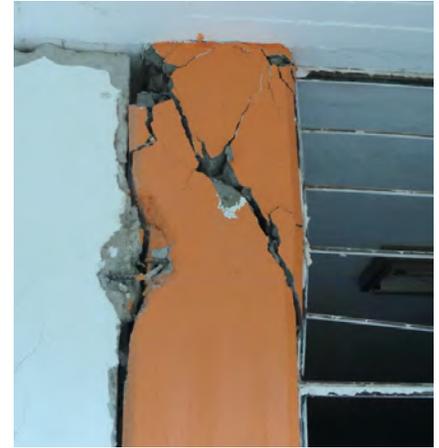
Agrietamiento por cortante en uniones viga-columna en marcos de concreto con muros diafragma.
